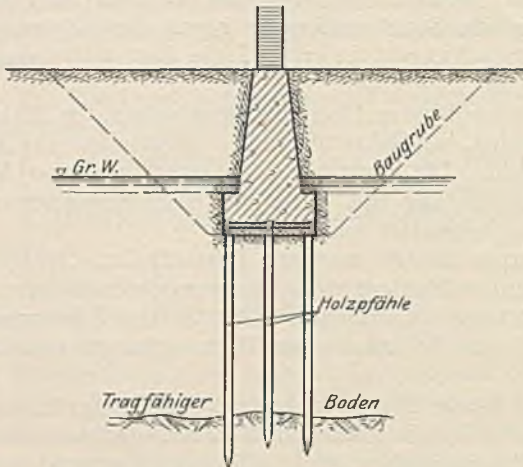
Tiefliegende Pfahlgründung auf Holzpfählen.
